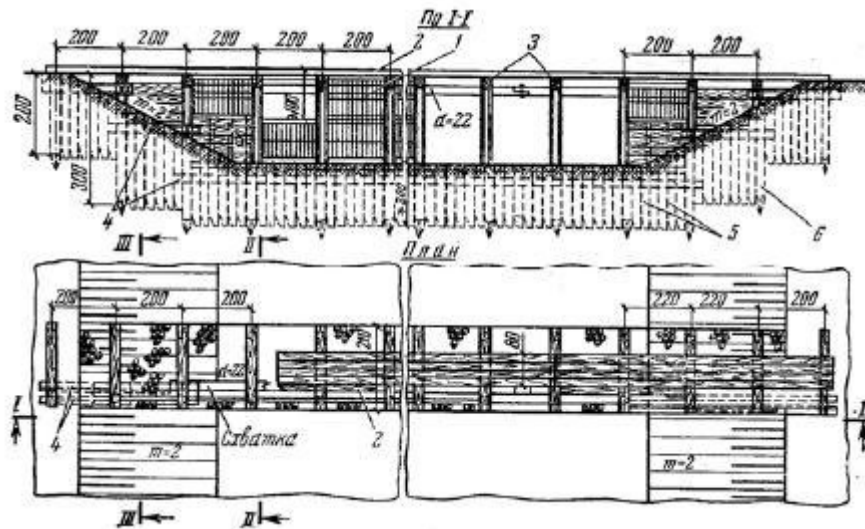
Верховина: 1 - металева сітка; 2 - настил з дощок; 3 - насадка; 4 - напрямні колоди; 5 - дощатий шпунт; 6 - маякові палі
